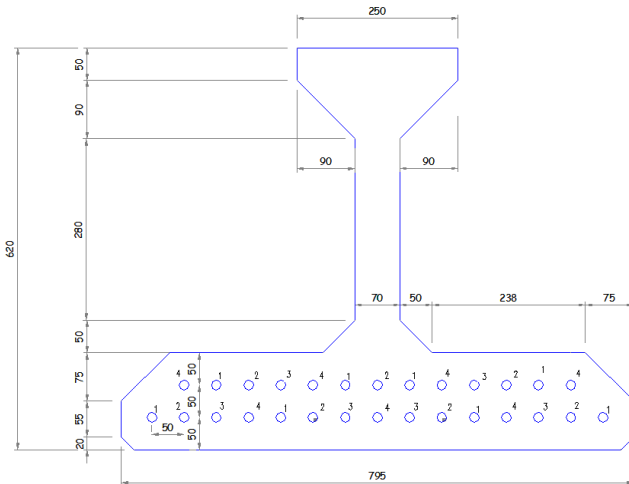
Pont Pinel - Coupe transversale d'une poutre (section standard)
